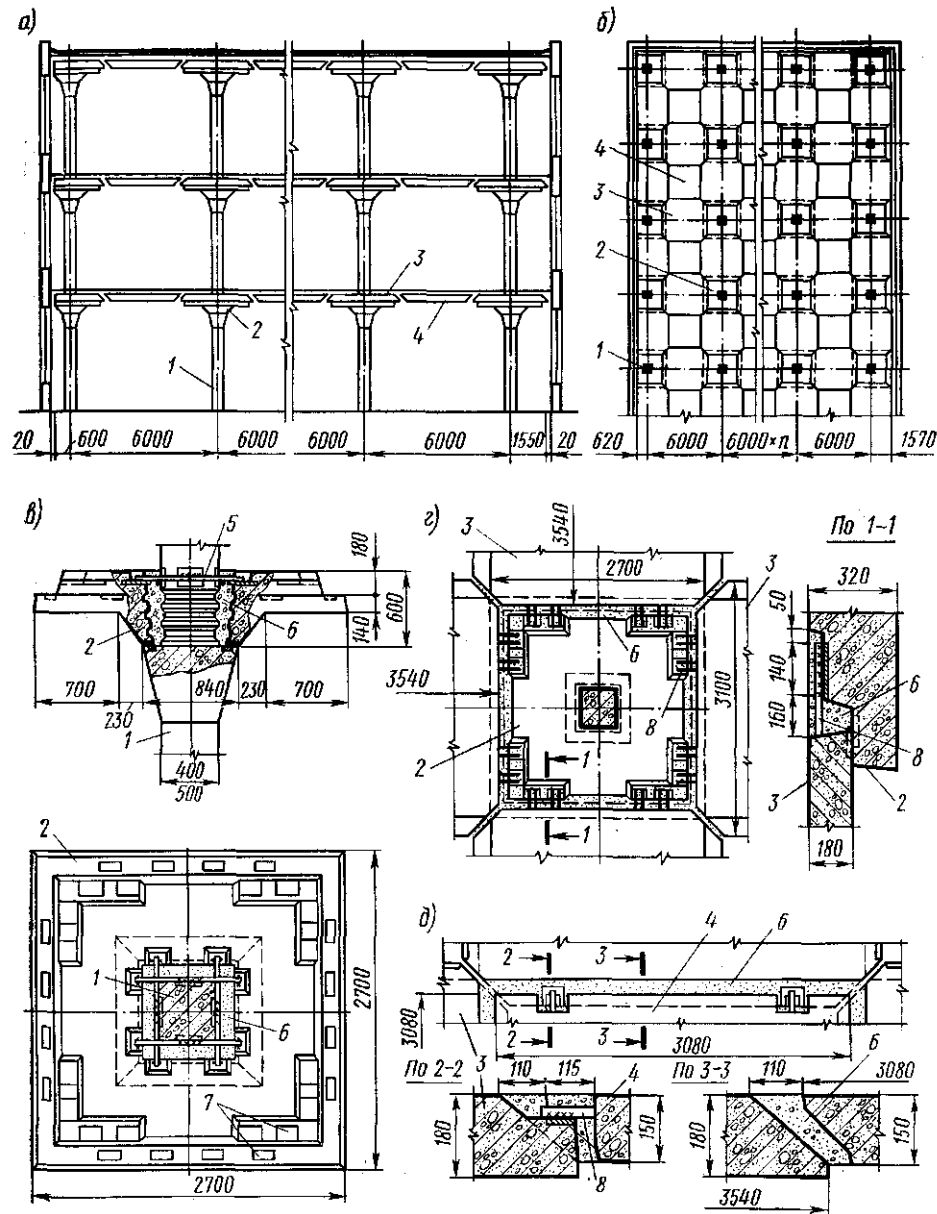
Многоэтажное здание с безбалочным каркасом:
